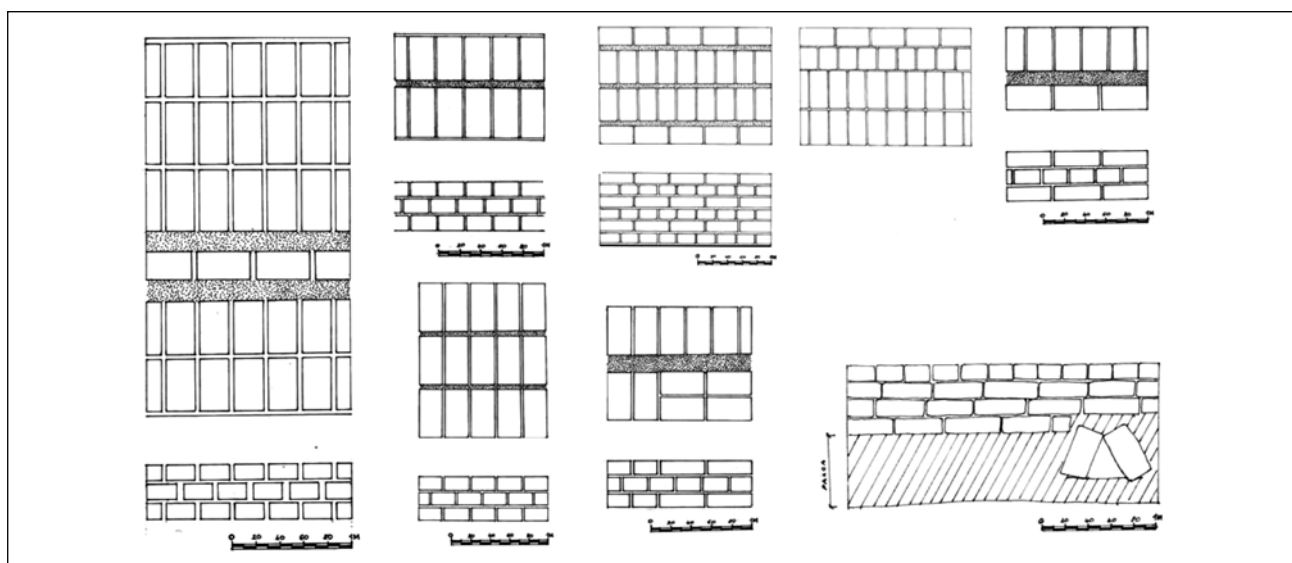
Конструкция кирпичной кладки внешних оборонительных стен и башен.
